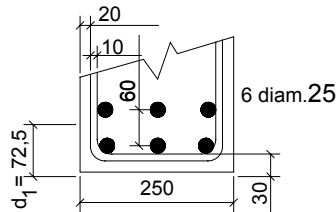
Distribución propuesta para las barras de la viga principal
